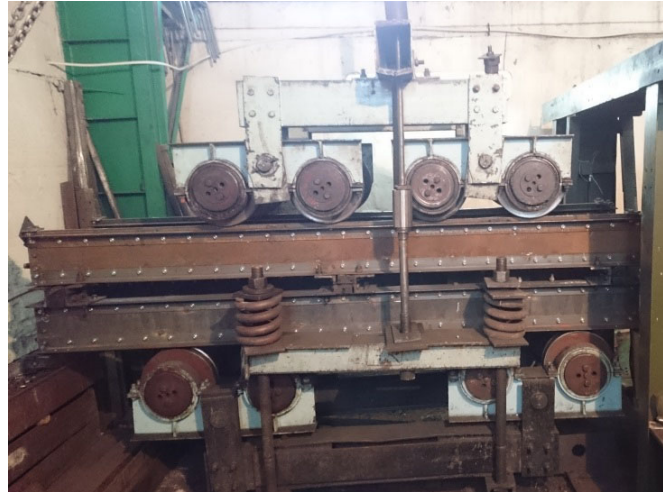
Стенд для испытаний на выносливость подкрановых балок
